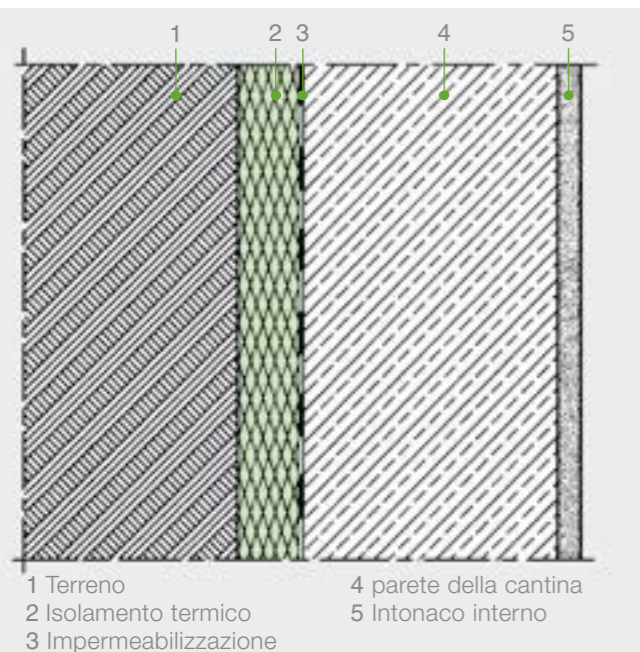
Parete di cantina con strato termoisolante esterno, a contatto con il terreno.
